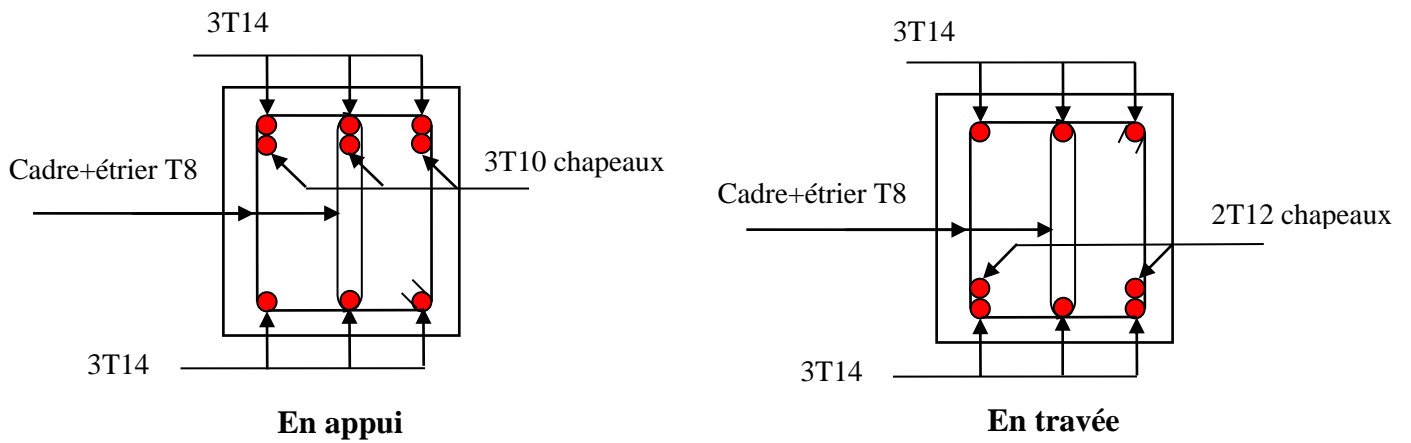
Schémas de ferrailage des poutres principales RDC
